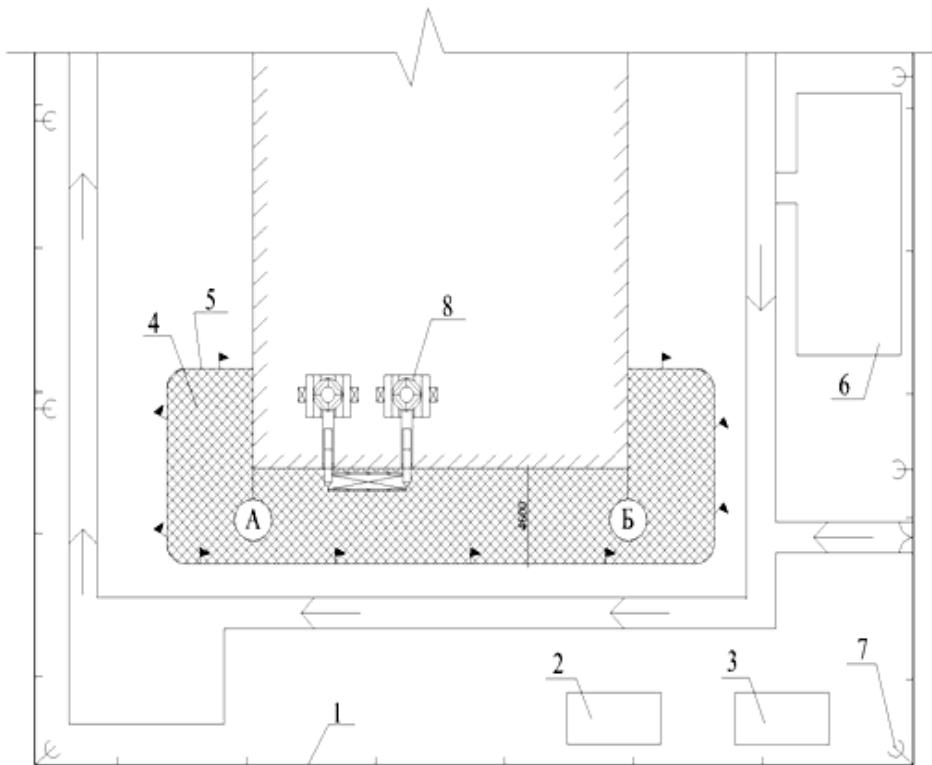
Площадка монтажных работ с установкой фасадного подъёмника
